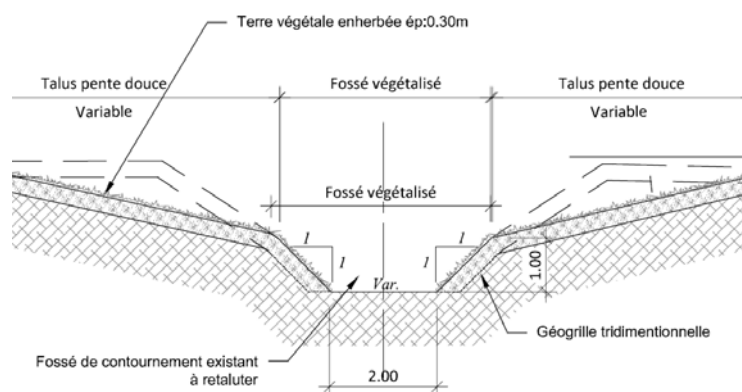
Extrait de coupe sur le fossé de dévoiement du ruisseau Las Fonds (source BRLi)
